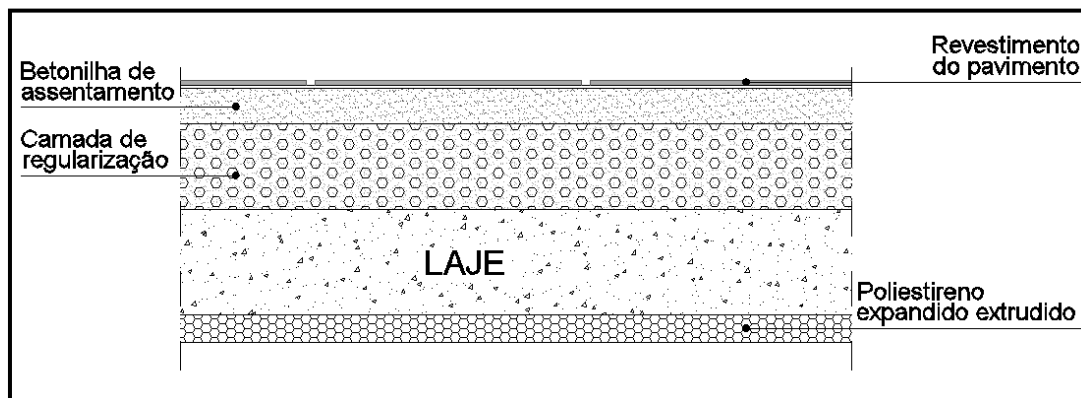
Pormenor do pavimento sobre a garagem, em corte (PAV01)
